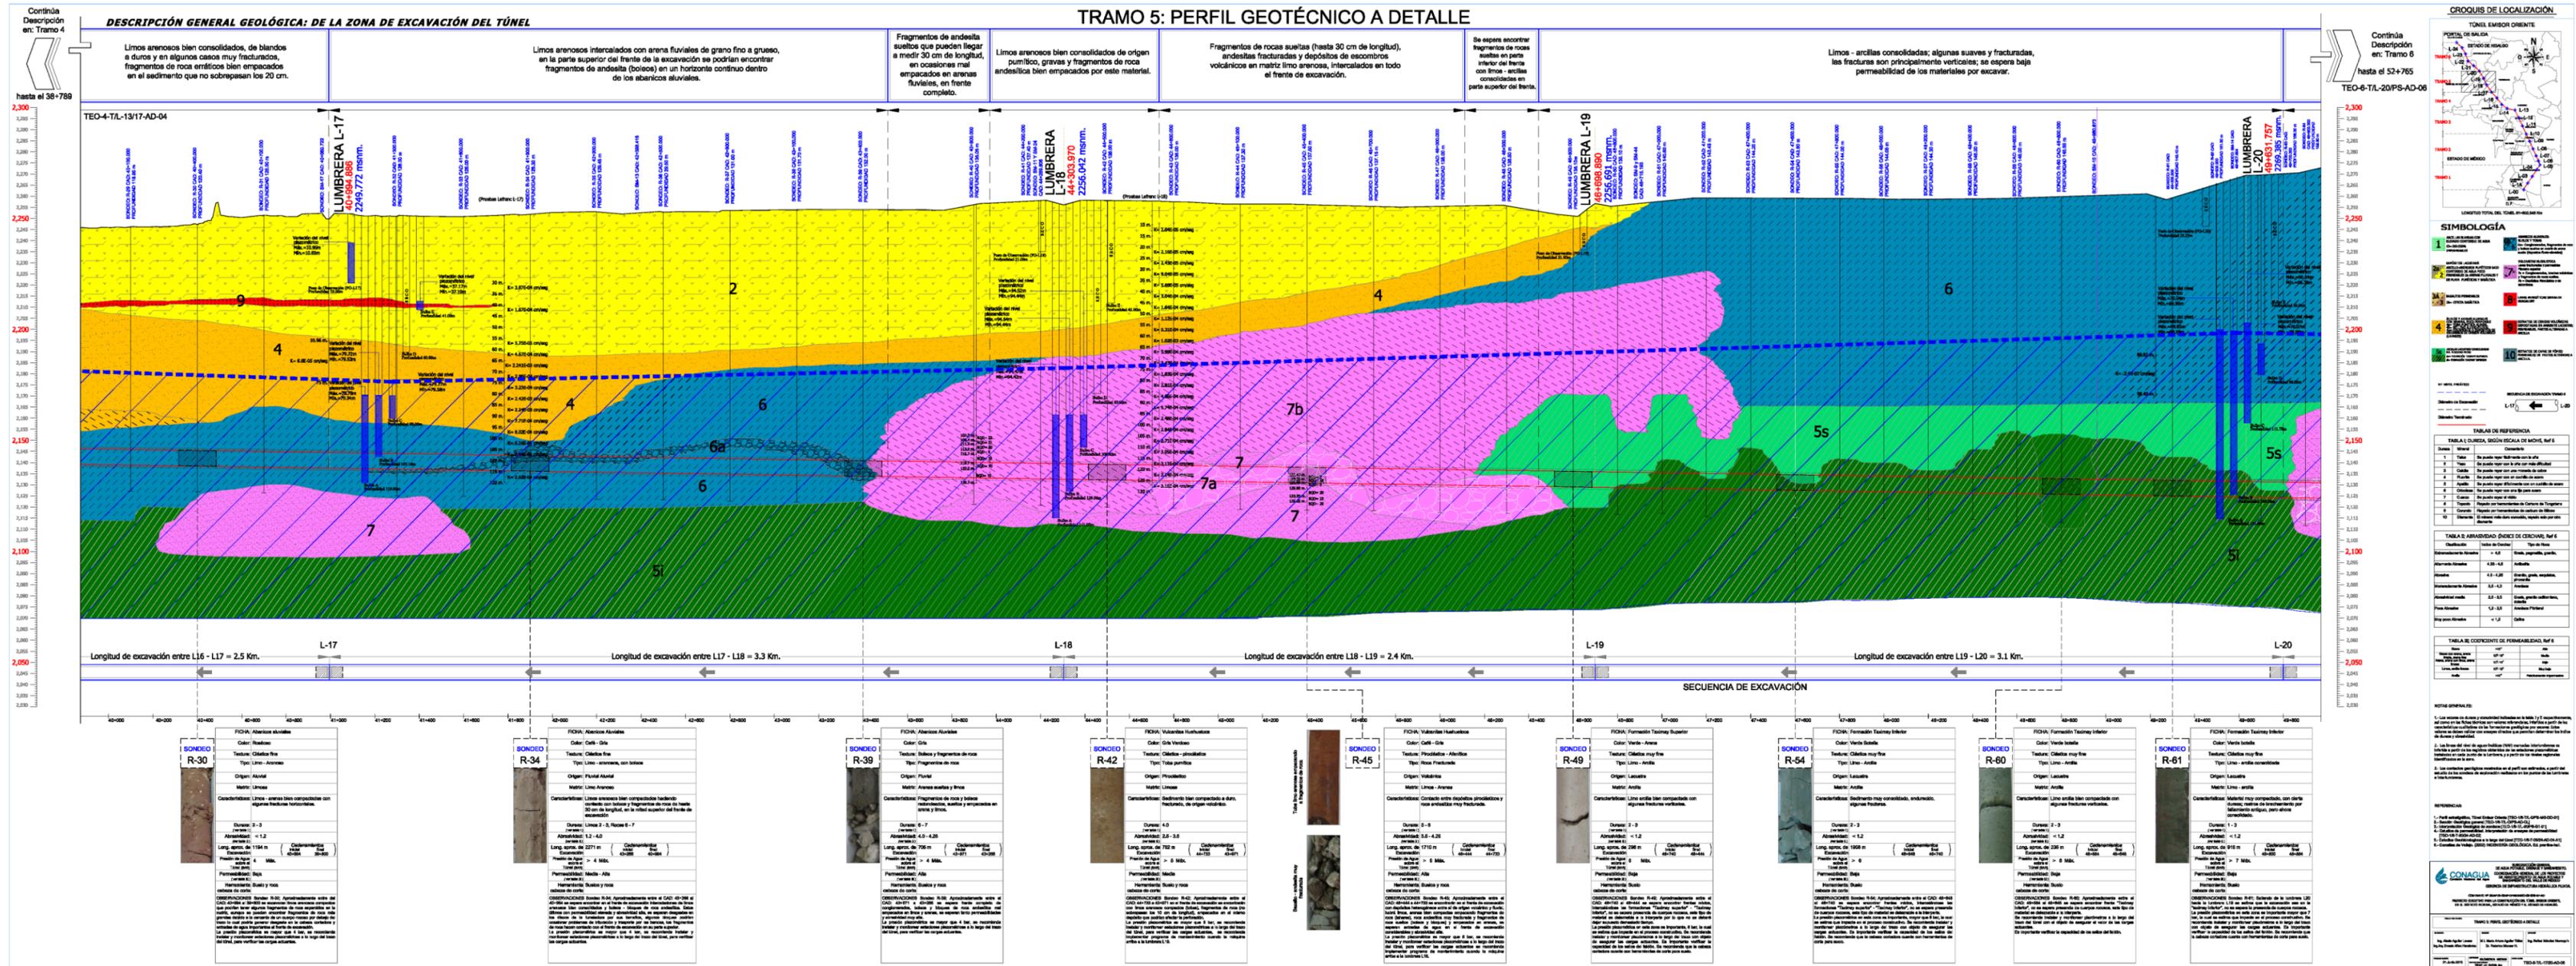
5 Perfil geotécnico a detalle TRAMO V, Túnel Emisor Oriente.
